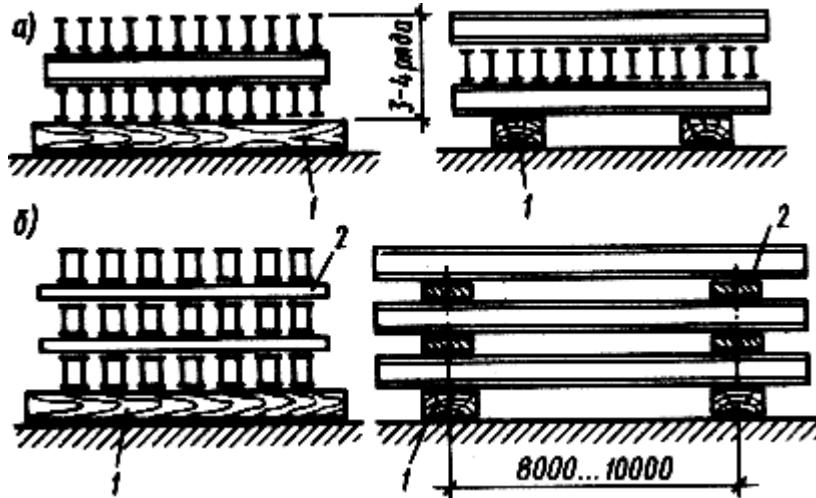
Складирование стальных элементов конструкций в многоярусных штабелях:
